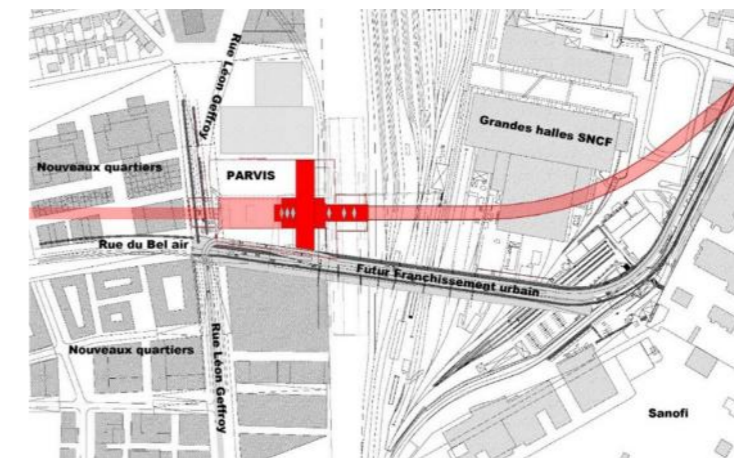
Plan de situation locale avec projet connexe (1/5000ème) – VPA 28/11/2014
